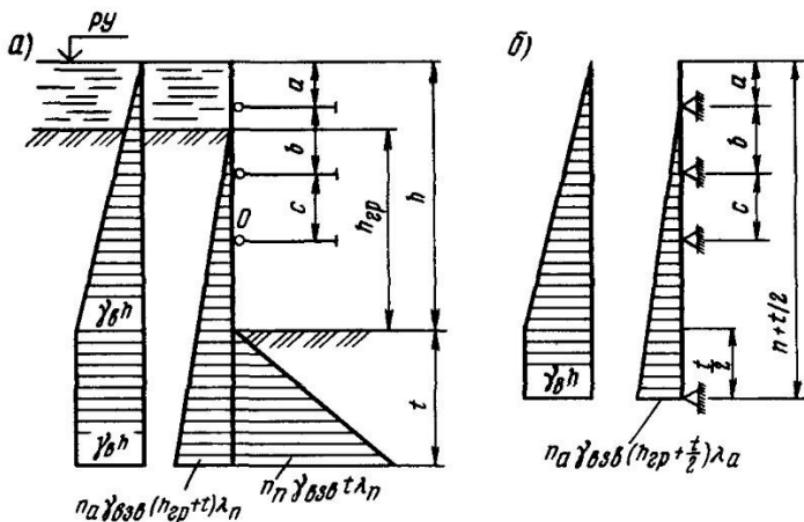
Схемы расчета шпунтовых ограждений с двумя и более ярусами креплений:
